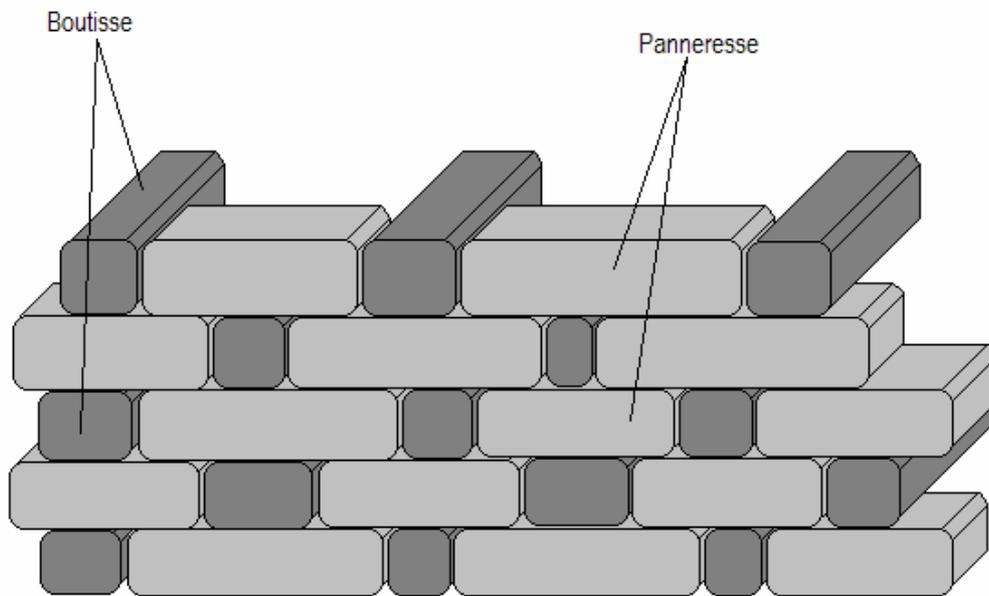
Croisement des pierres dans le mur, vue 3D
